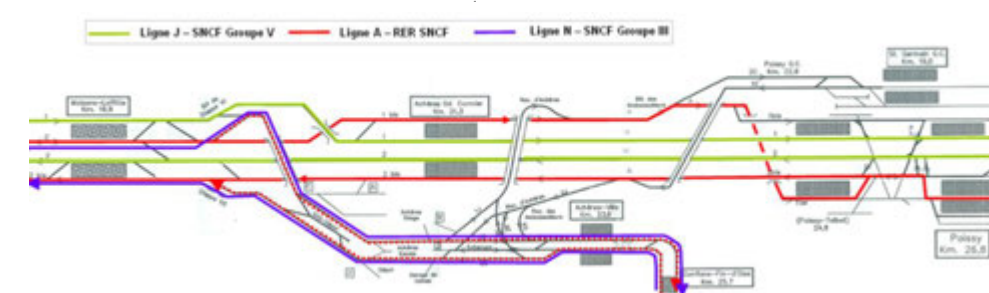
Plan de voies entre Poissy et Maisons-Laffitte via le secteur Achères Grand Cormier
